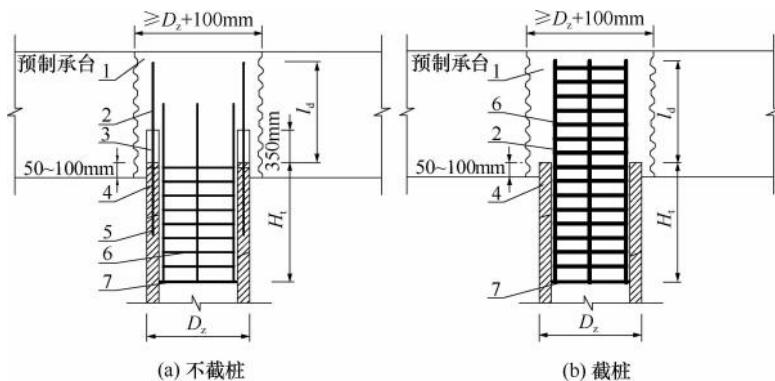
抗拔混凝土空心桩、钢管混凝土管桩与承台连接
